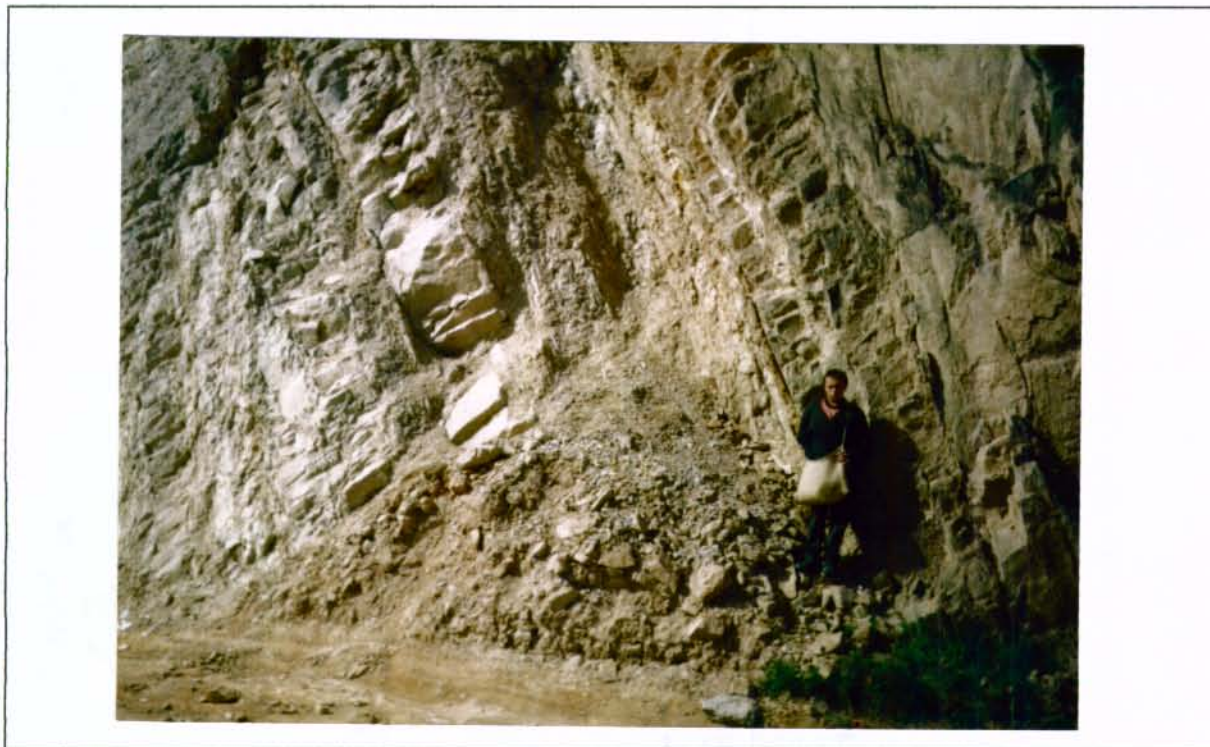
Corte para construcción de muro de contención por la Transversal 9E con 5 Sur. Suelo orgánico y residual, espesor apreciado aproximadamente 5 metros. Vista al NW. Foto EPR / Sept. 99. Cuadro 6, Rollo 8692
